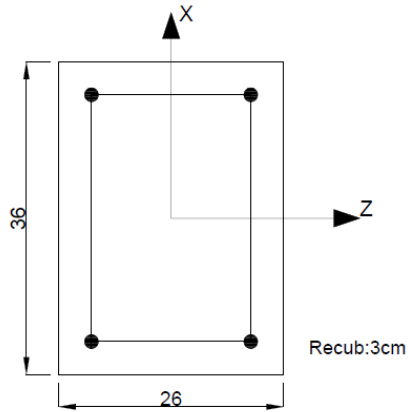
Sección transversal de la columna (dimensiones de la columna hormigonada)
